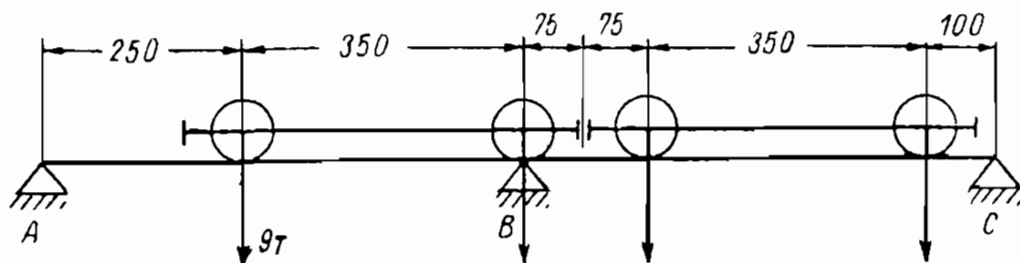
Расчетная схема для определения реакции колонны *B* от крановой вертикальной расчетной нагрузки
